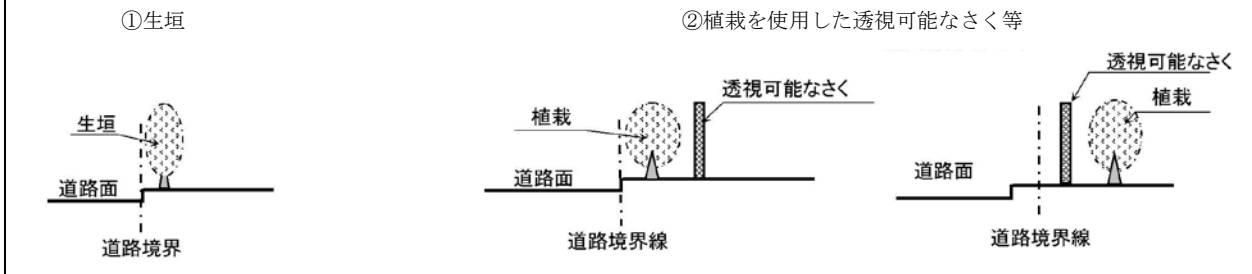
(8) 道路断面図(地区計画による植栽誘導のイメージ)
